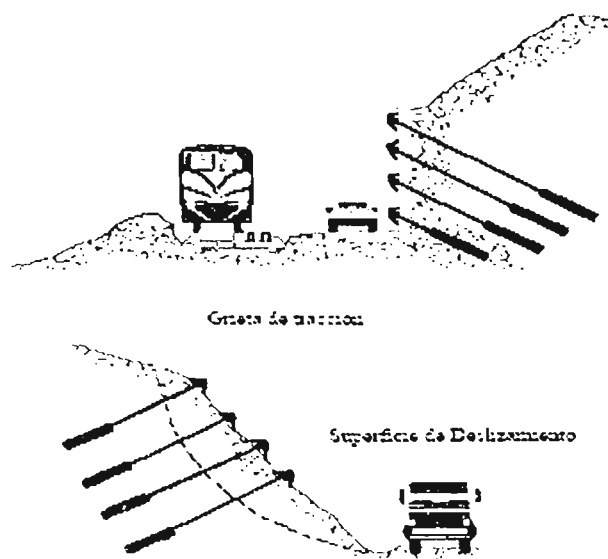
Aplicación de anclajes con otras estructuras de contención para estabilizar taludes.
